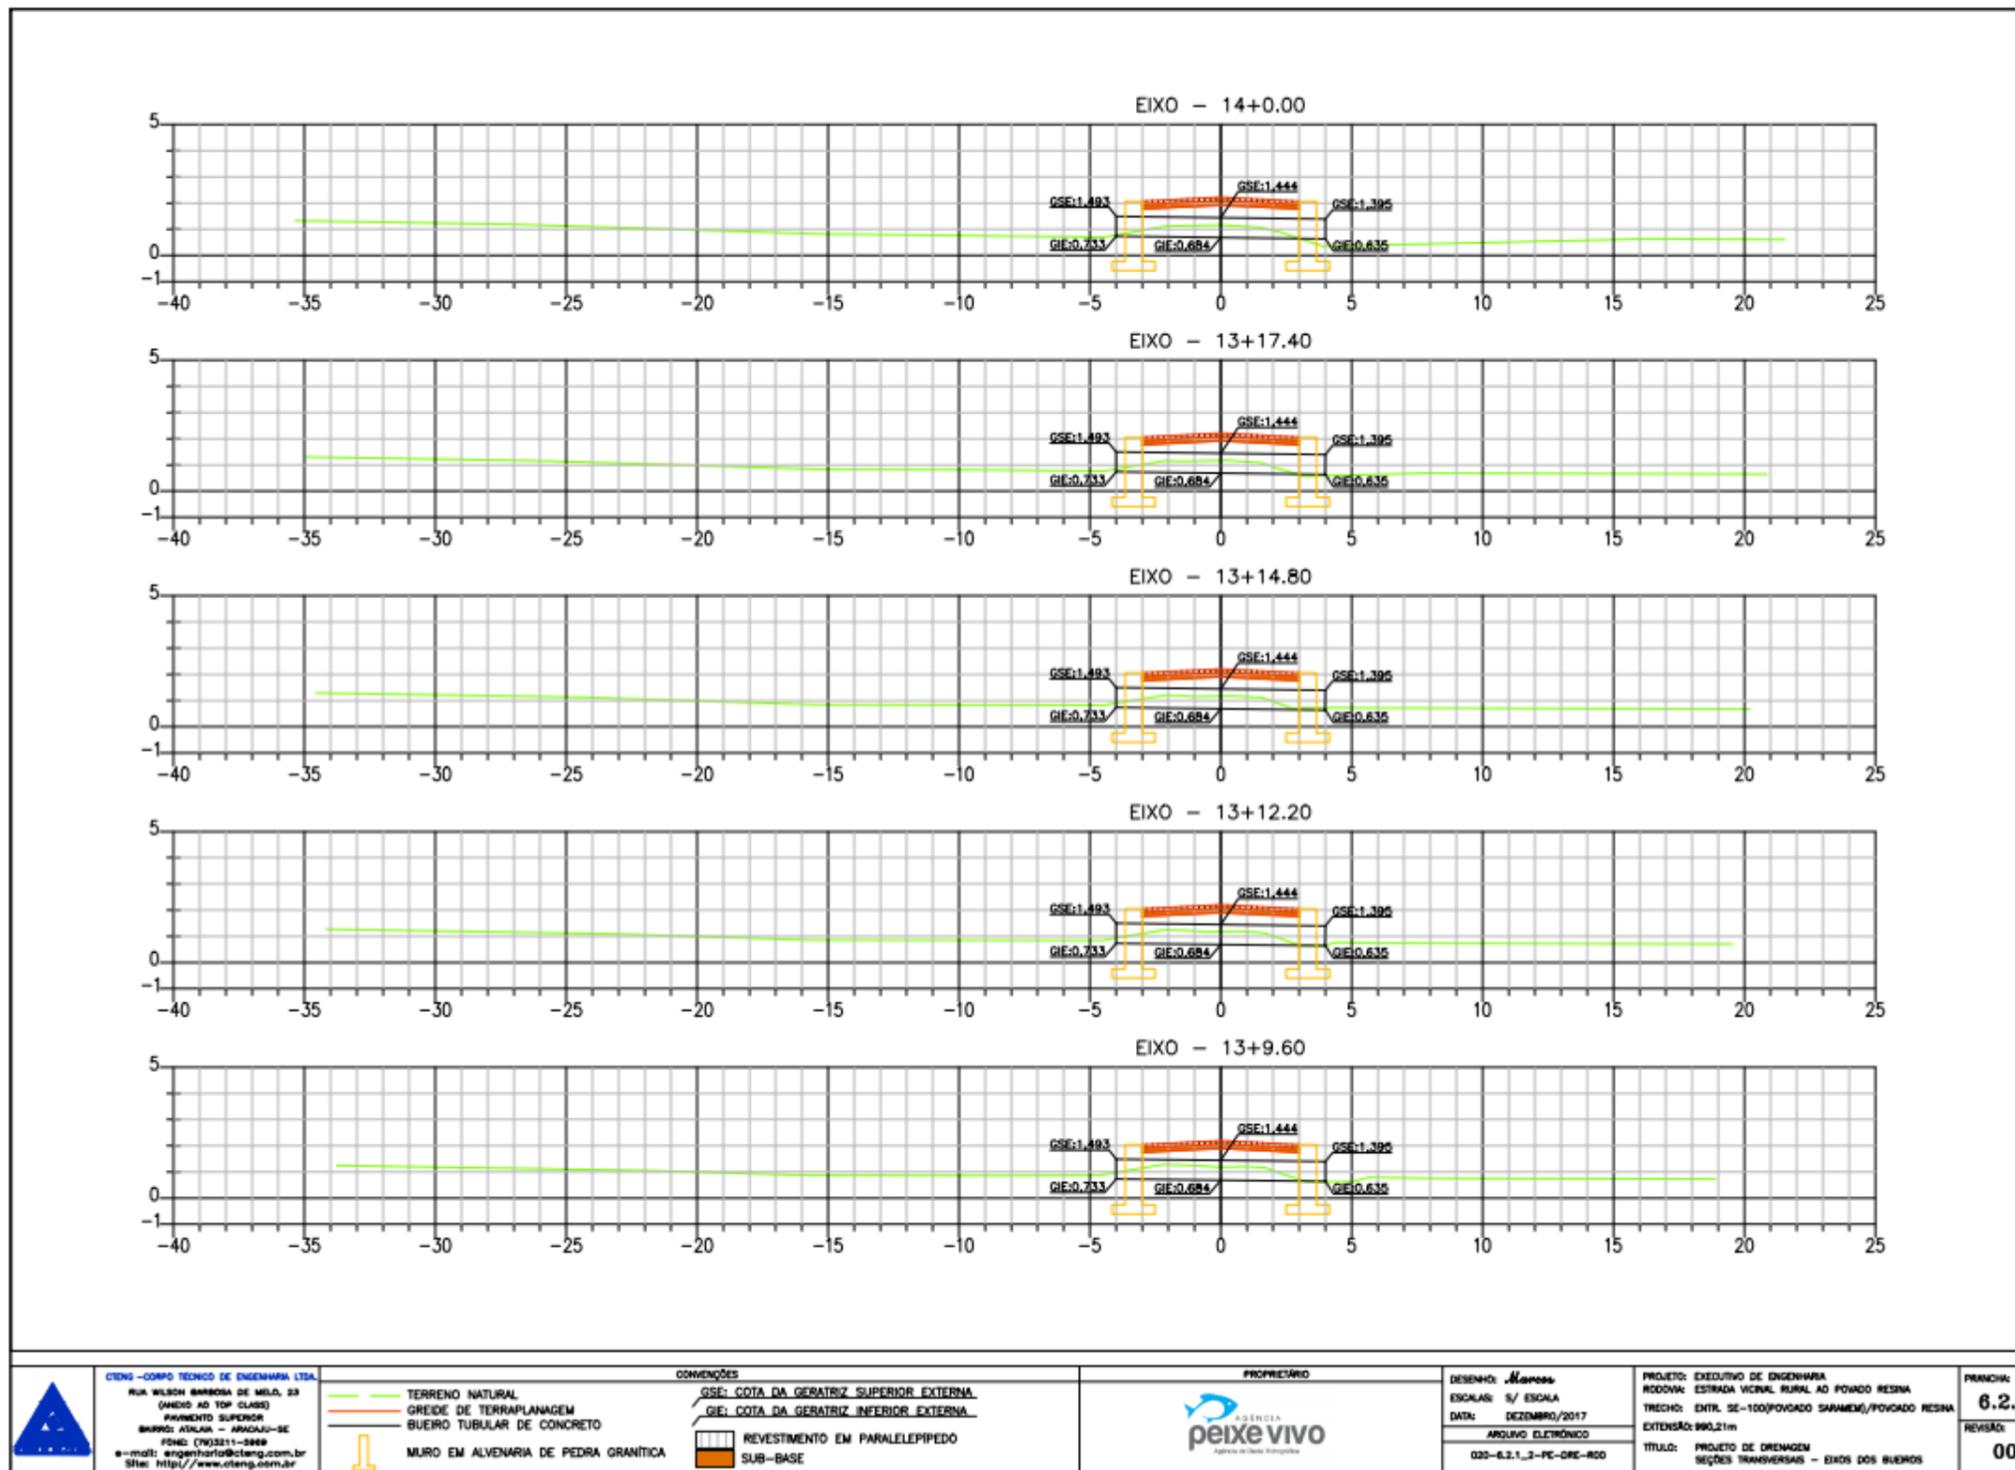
b - Seções transversais dos bueiros (1ª parte).
